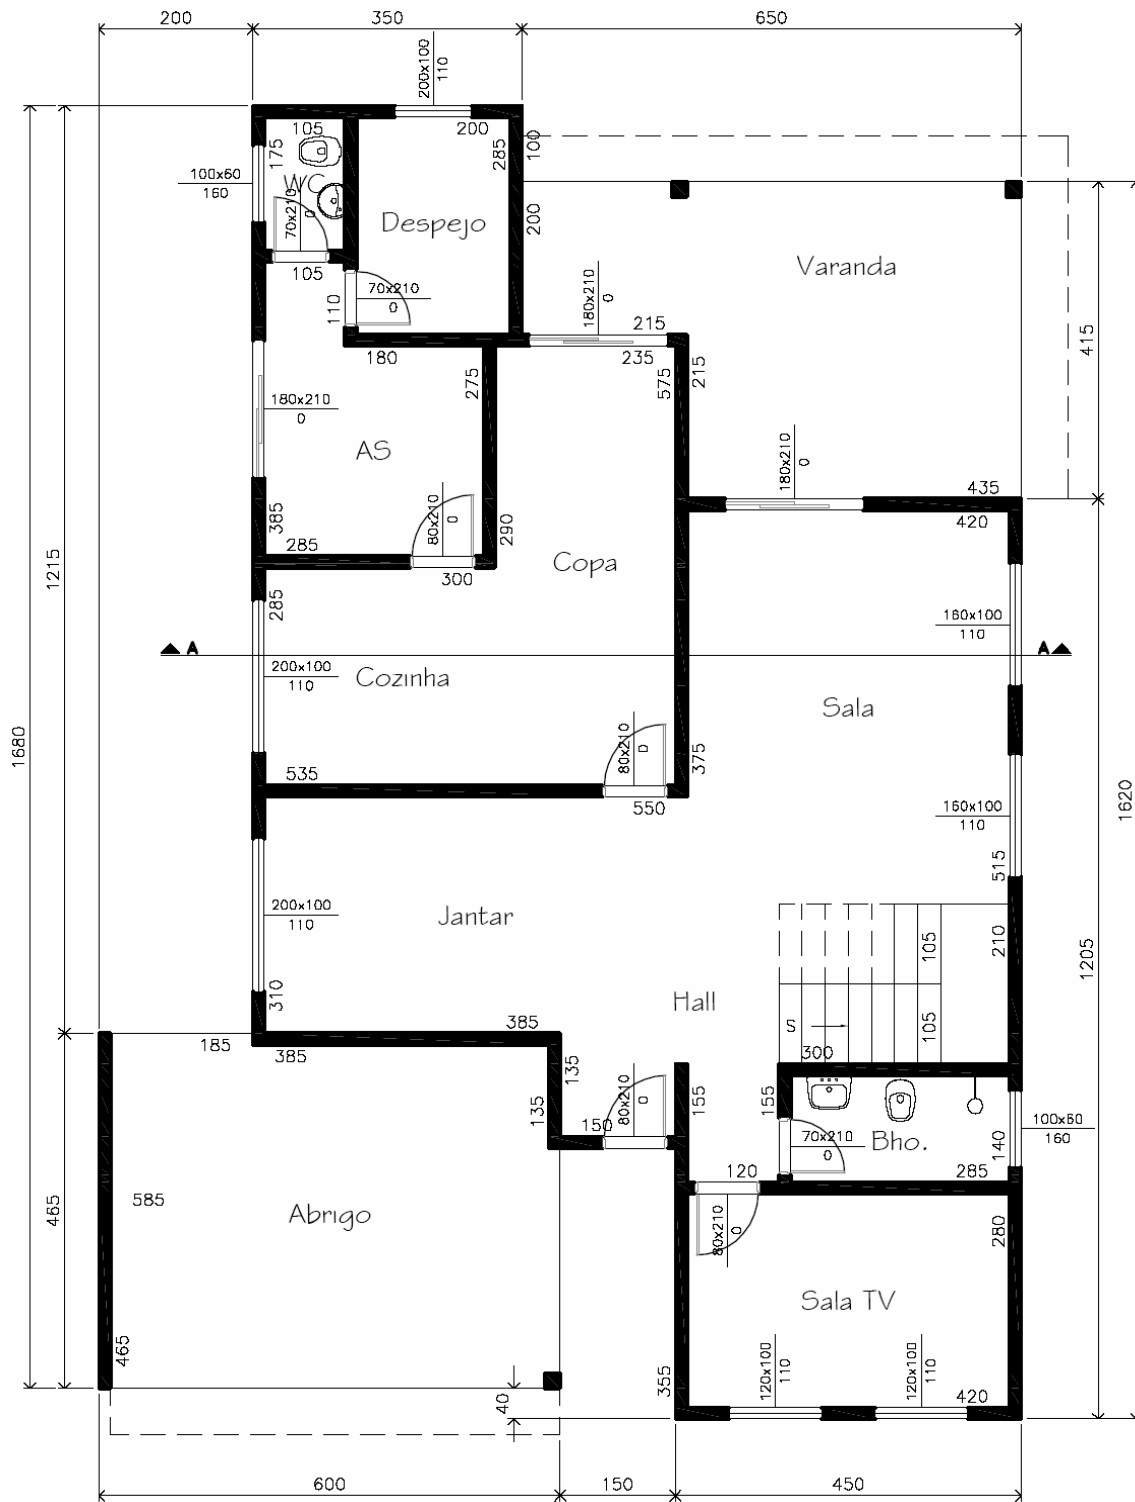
Arquitetura do Exemplo L: pavimento inferior
